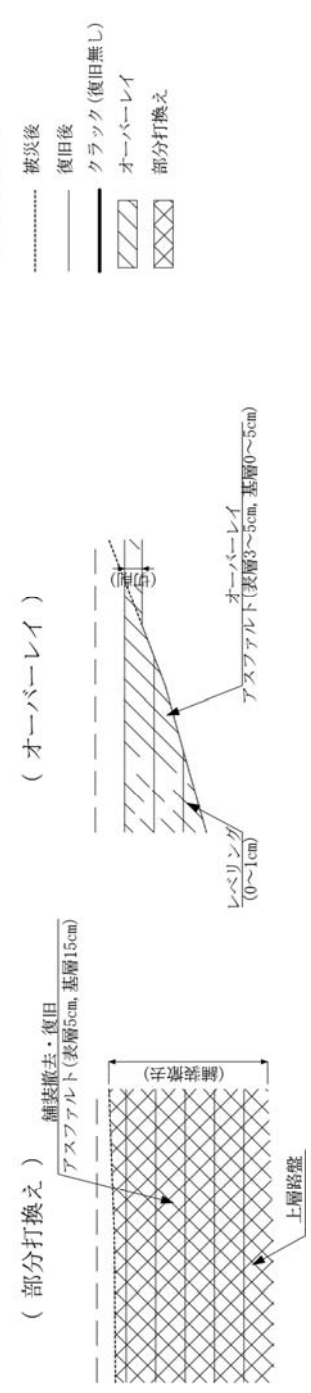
香椎パークポート地区-11m岸壁の被災・復旧標準断面図
